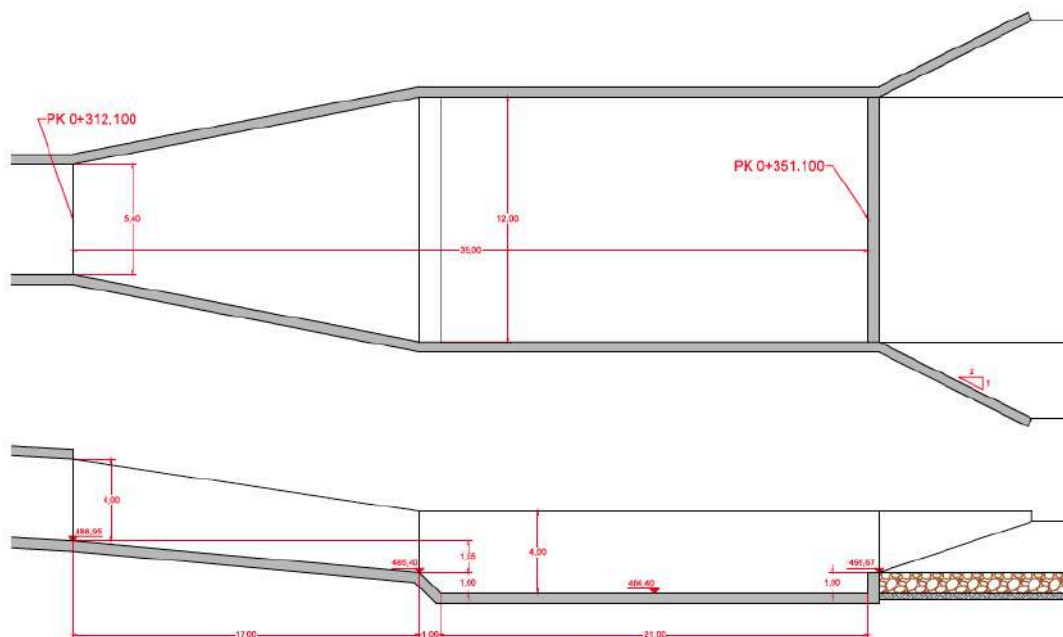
Planta y sección longitudinal del dissipador de energía (cotas en metros). FUENTE: Elaboración propia.
